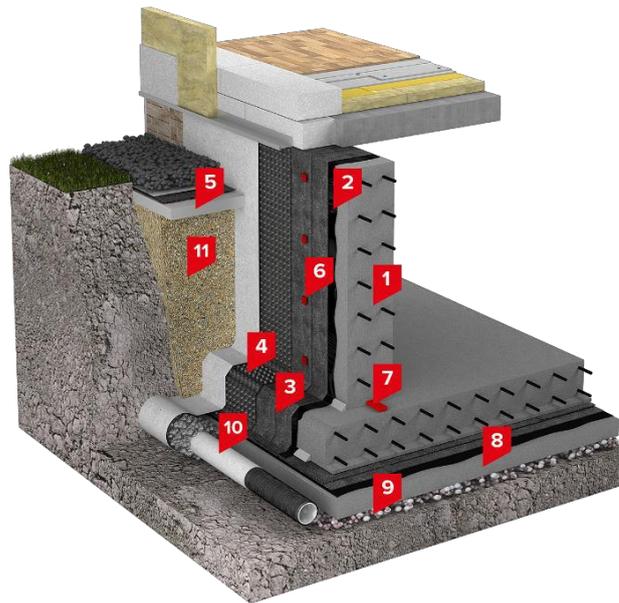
Конструктивное решение подземной части здания с ленточным фундаментом: 1 – железобетонные конструкции подвала; 2 – праймер битумный; 3 – рулонная гидроизоляция; 4 – профилированная мембрана; 5 – экструзионный пенополистирол; 6 – крепеж для фиксации плит и мембраны; 7 – набухающий шнур; 8 – бетонная подготовка; 9 – щебеночная подготовка; 10 – дренажная труба; 11 – грунт обратной засыпки
